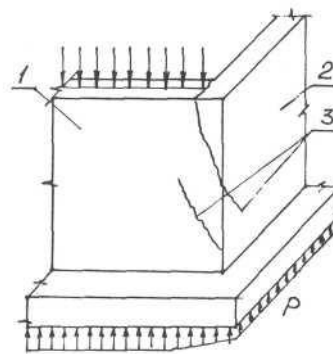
(1 – несущая стена, 2 – самонесущая стена, 3 – трещина)
